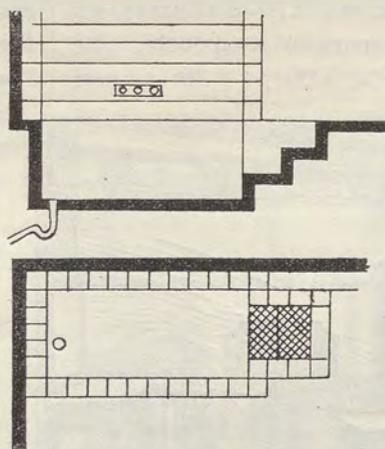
Sezione e pianta di una vasca massiva approfondita nel pavimento.
